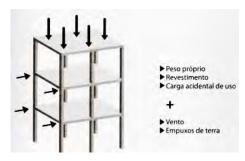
Carregamentos horizontais e verticais em estruturas. Fonte: KIMURA (2018)
